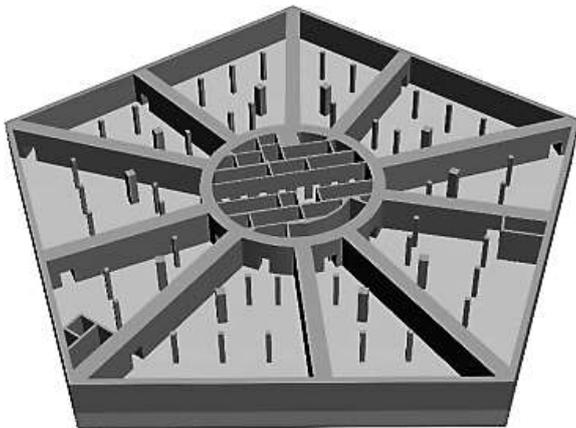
Пространственная схема коробчатого фундамента здания «Лахта Центр»
